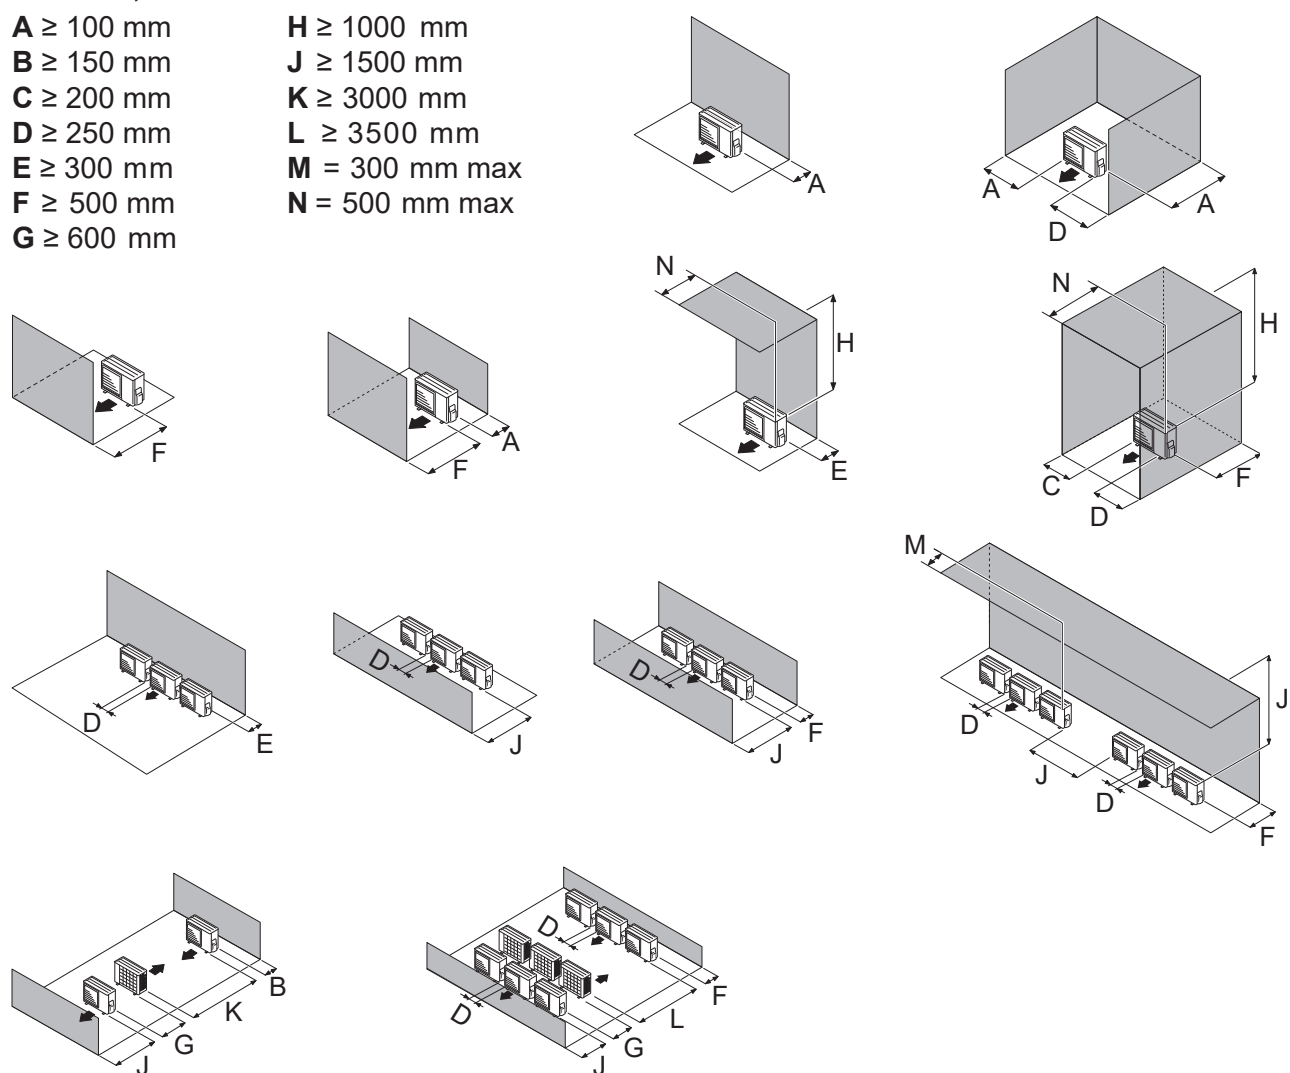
Minimale installatieruimte rond de buitenunit (model 10)
